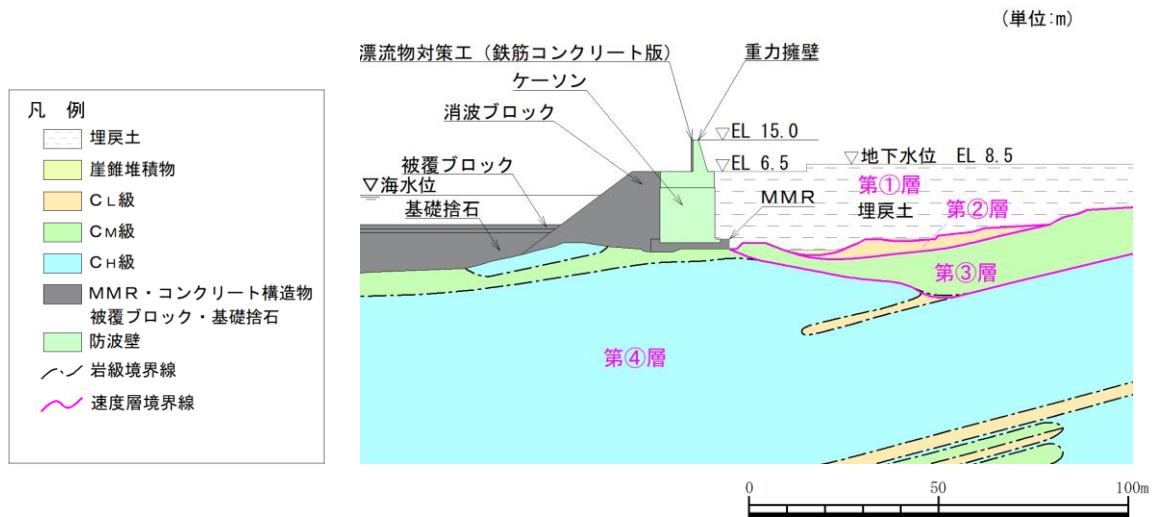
(1) 地質断面図（防波壁（波返重力擁壁）①-①断面（参考））
